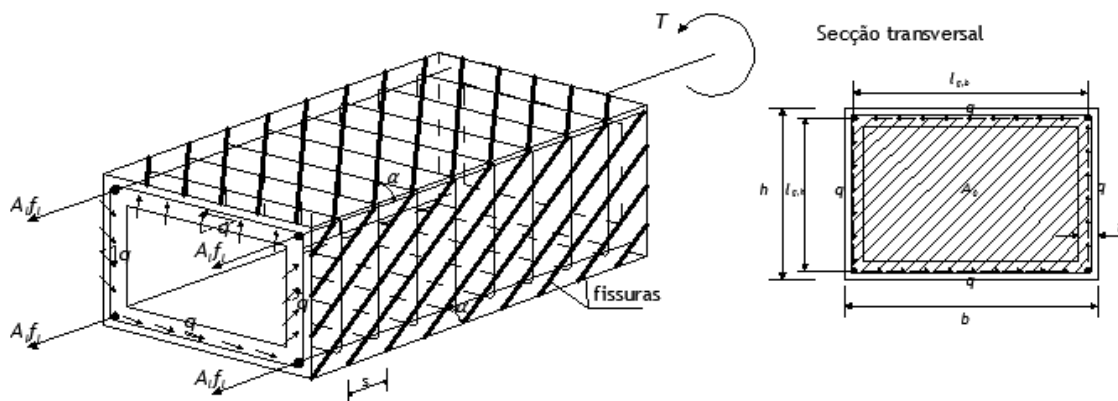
Viga com secção retangular vazada sujeita à torção pura
